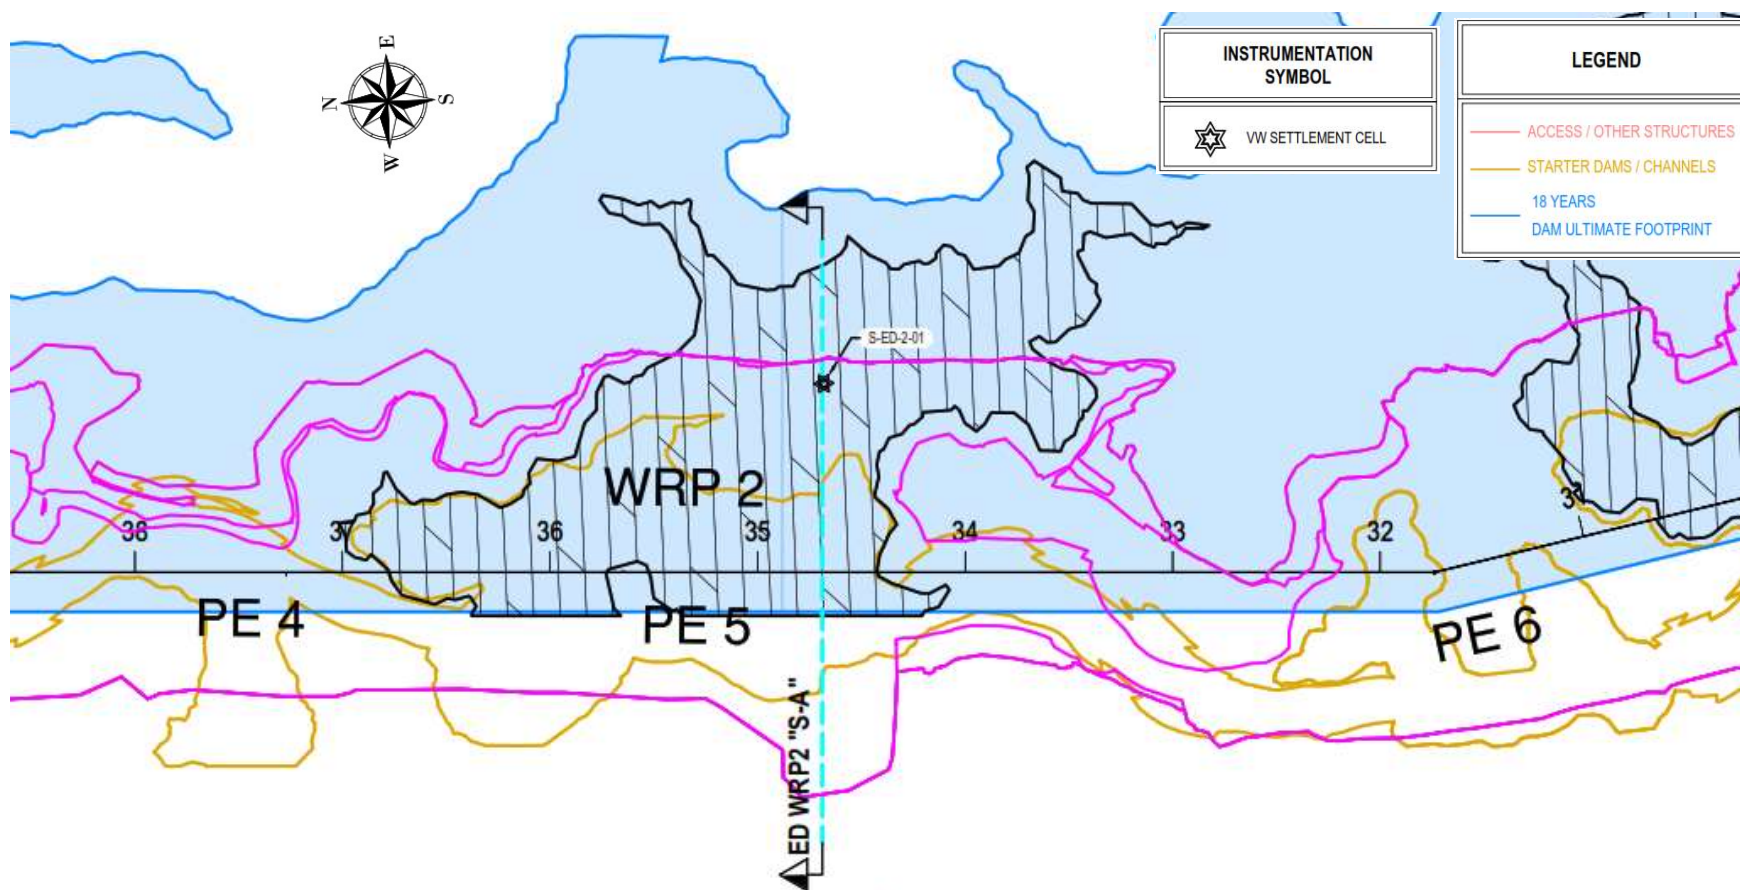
1: Vista en planta de la PE WRP2 – Grupos de instrumentos de la celda de asentamiento
